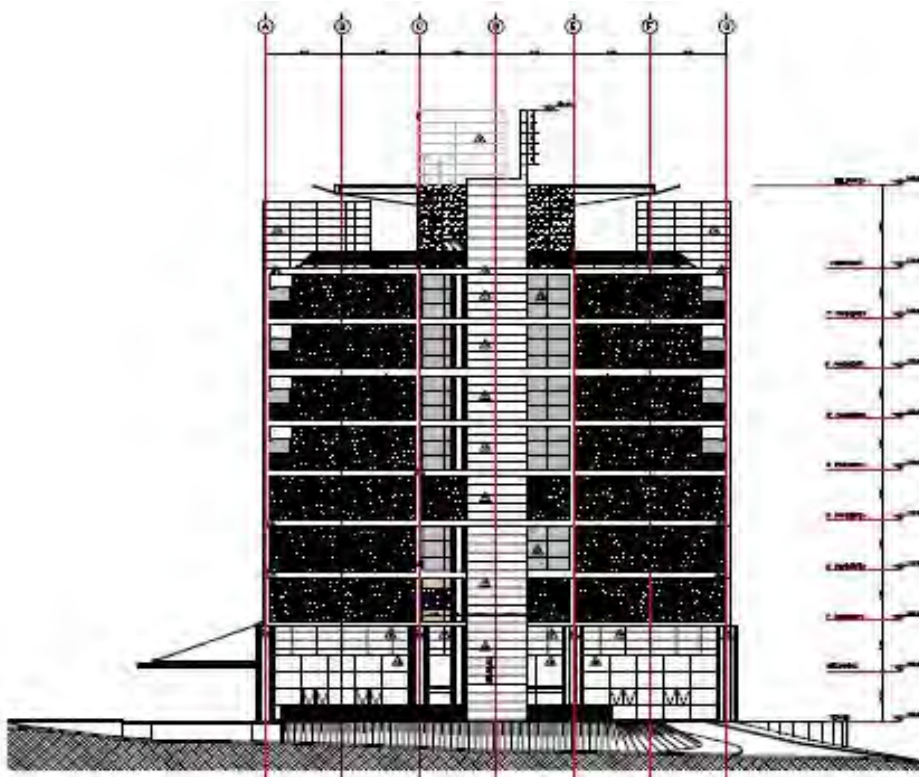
Fachada Oeste – Rua Manoel Atouquia.
